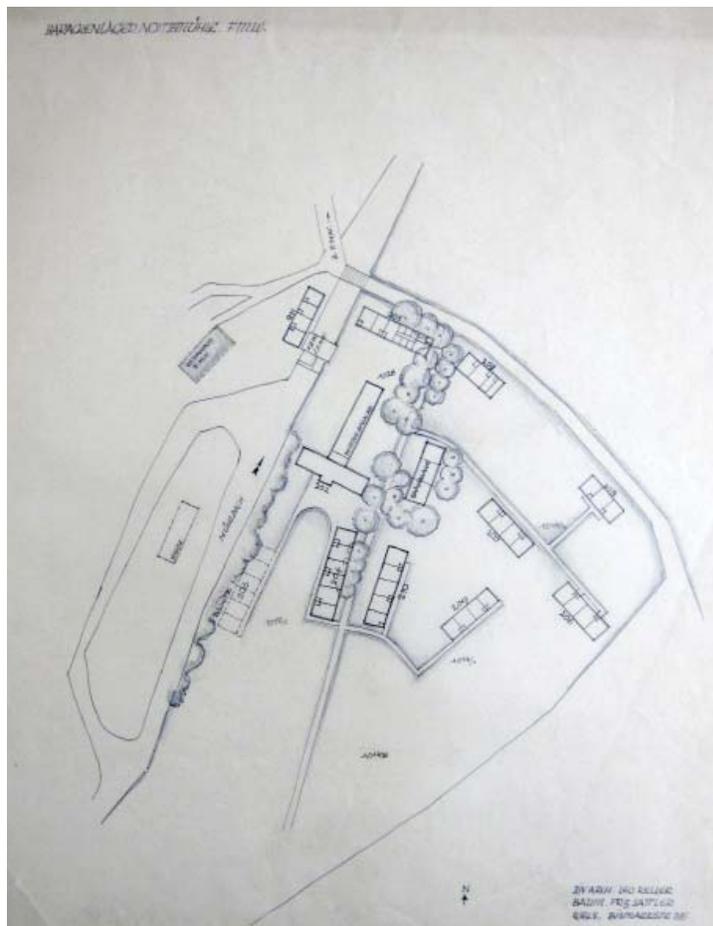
Lageplan Noitzmühle um 1940, Architekt Leo Keller
